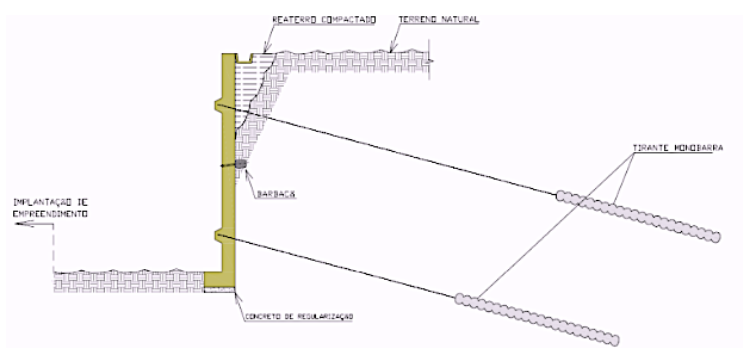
Seção transversal do modelo proposto da cortina atirantada
